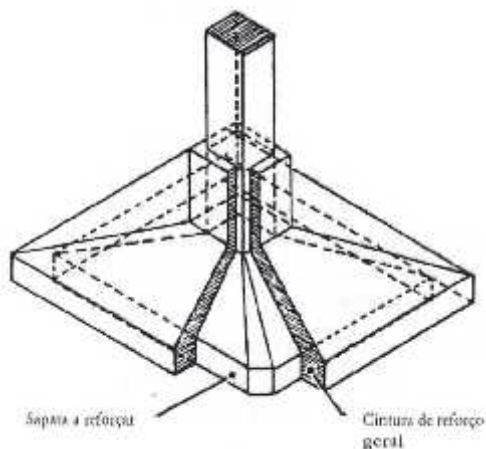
Reforço de sapata de betão armado por cinturagem de betão armado (coelho, 1996).
